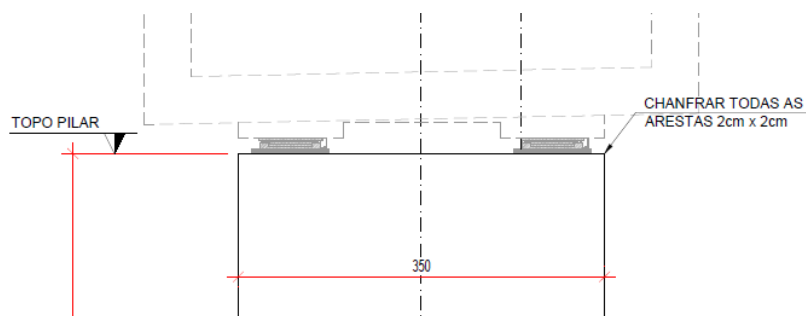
DETALHE DO TOPO DOS PILARES
